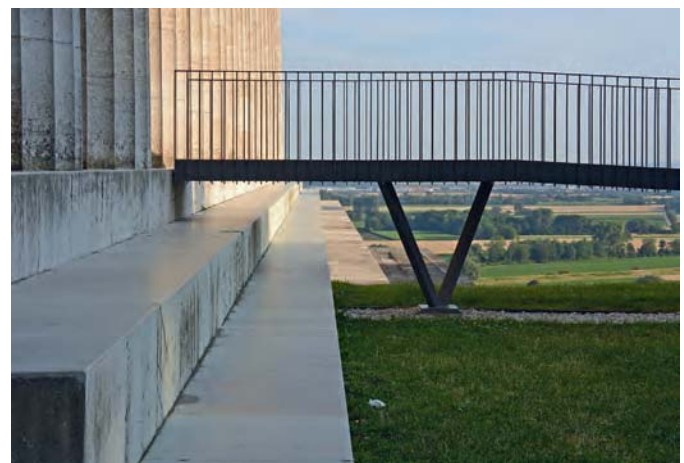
, 62 Barrierefreiheit am Baudenkmal: additive moderne Rampe (Fotos: BLfD, Bildarchiv/Klaus-Jürgen Edelhäuser)
